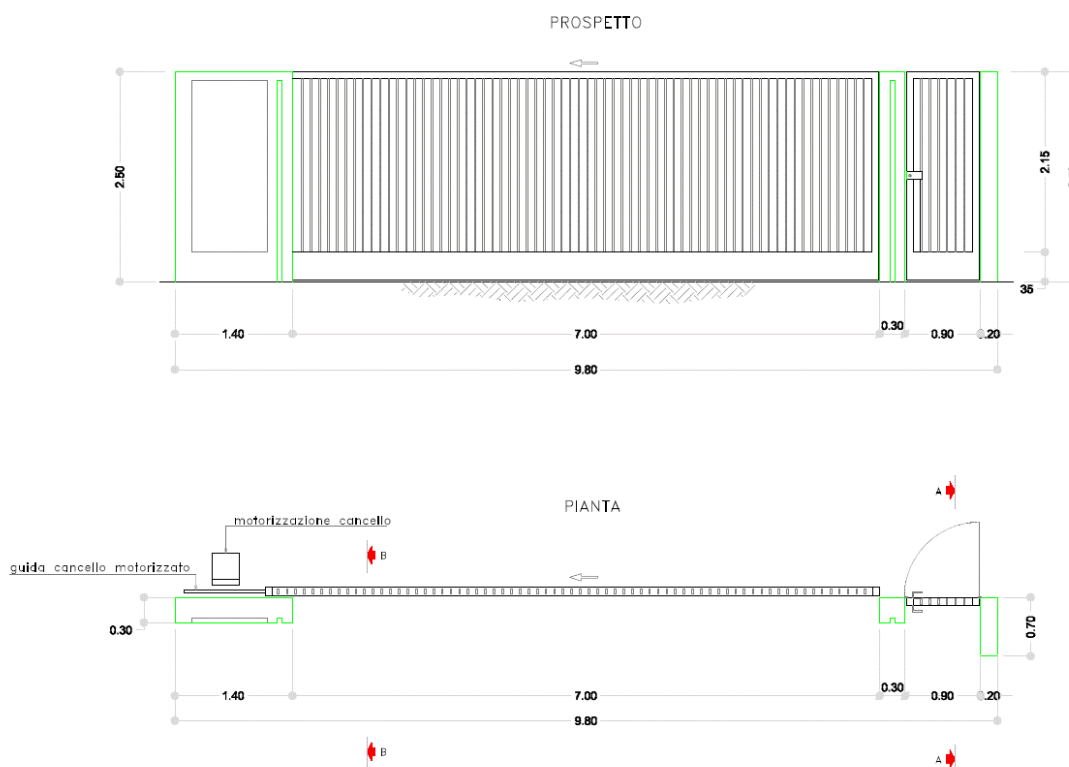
Prospetto e pianta del cancello carrabile
